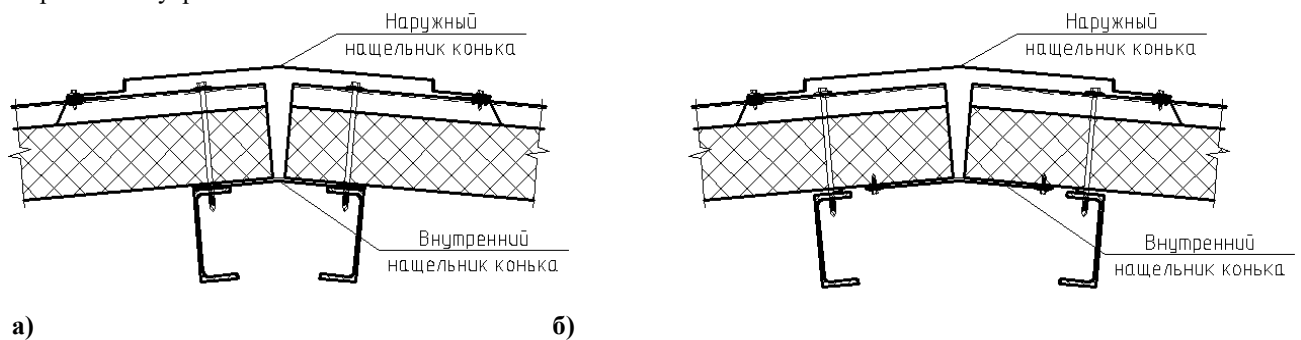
Коньковый узел двускатной кровли из кровельных панелей Технопан
